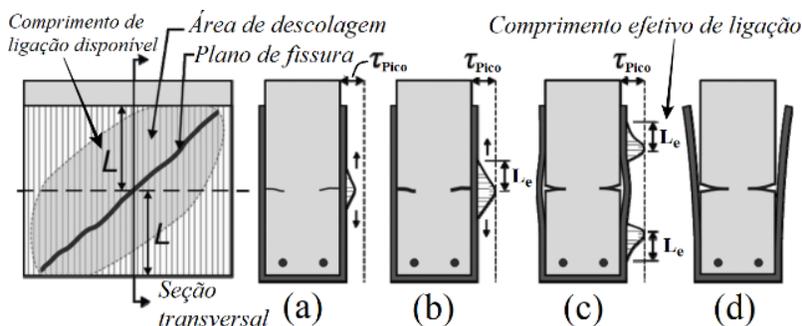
Processo de descolagem de vigas em concreto armado reforçadas ao cisalhamento em U.
